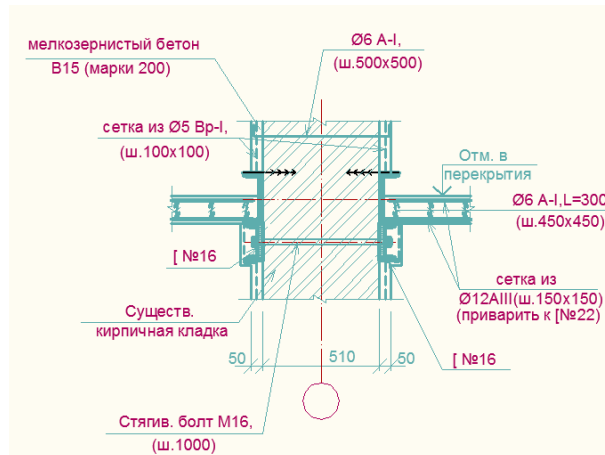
Узел крепления нового монолитного перекрытия со стенами
